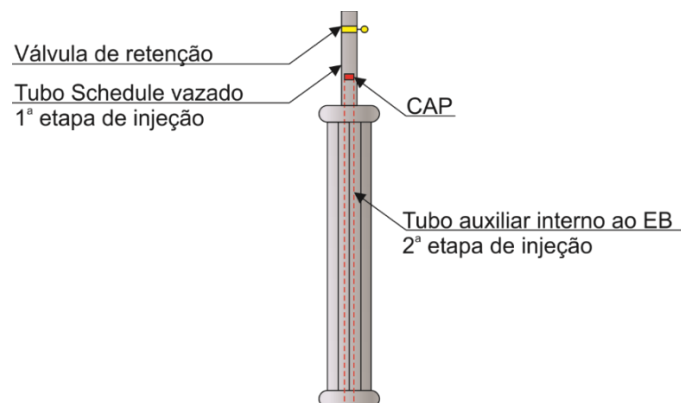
Detalhe do tubo auxiliar que passa por dentro do EB.
